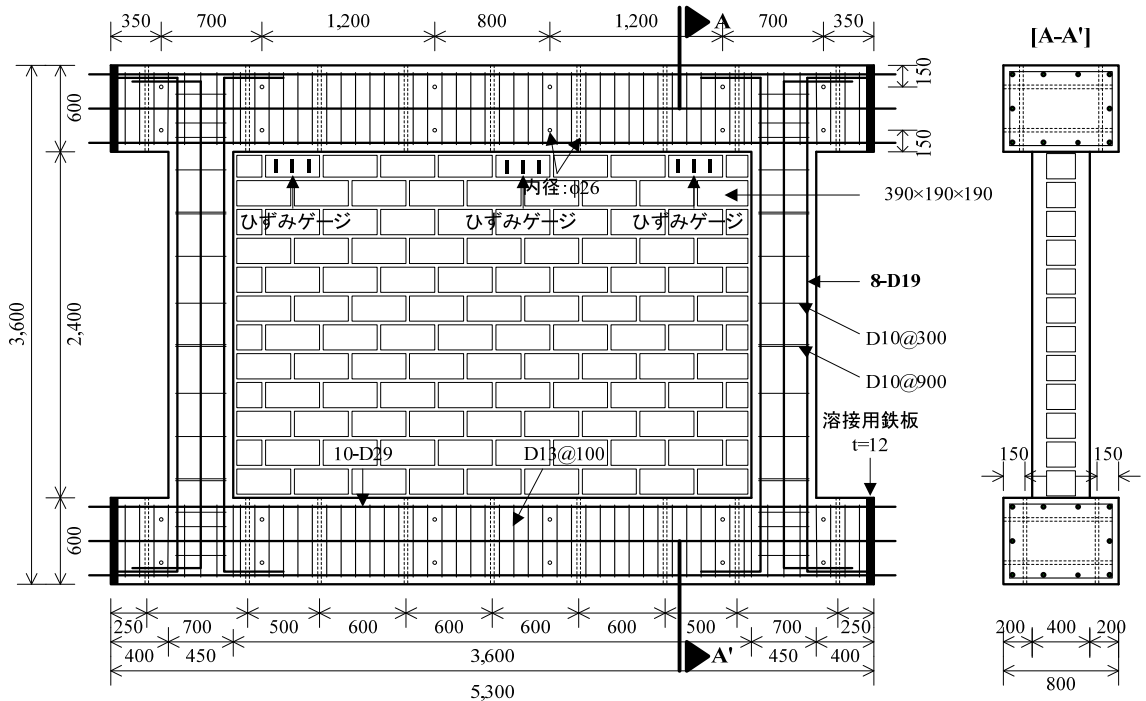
IW4 試験体の詳細（単位：mm）（文献[2.1]に基づき作成）
